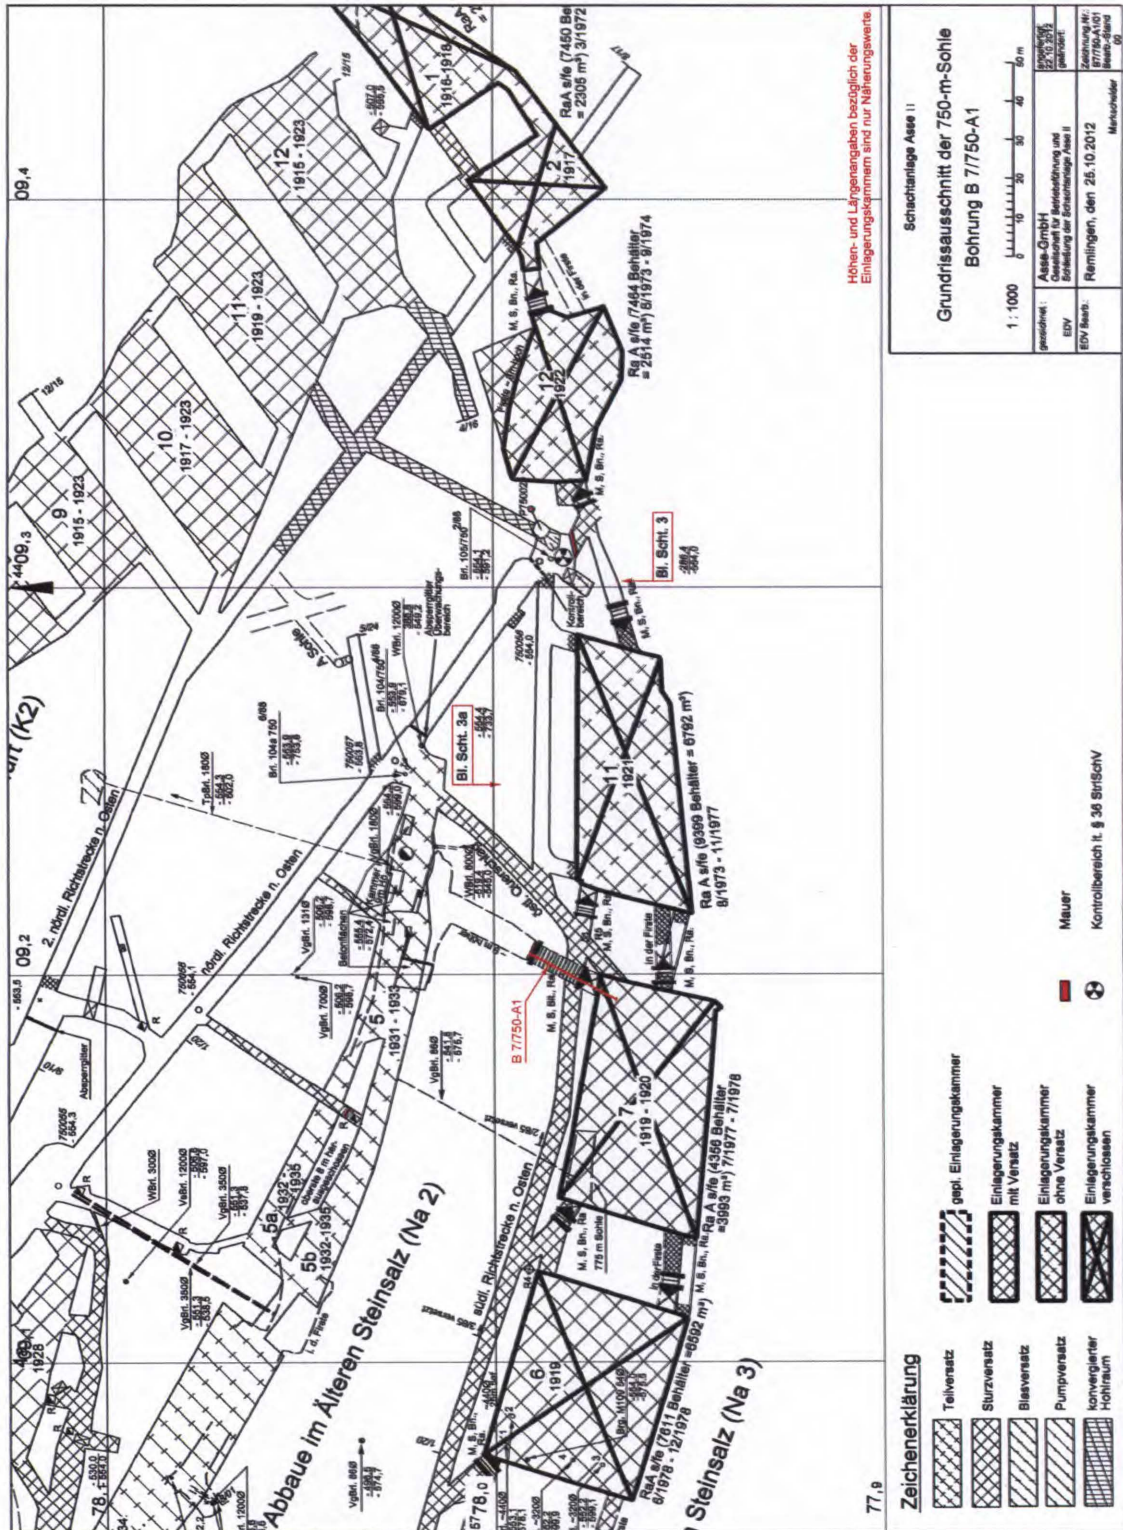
Grundrissausschnitt der 750-m-Sohle mit dem geplanten Verlauf der Erkundungsbohrung B 7/750-A1
